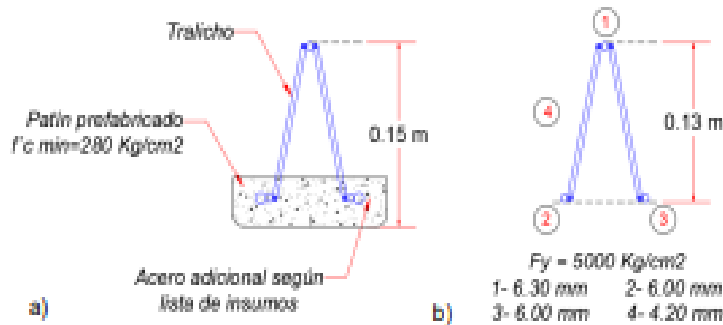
Esquema de las viguetas prefabricadas: a) Viguetas totalmente prefabricadas, b) Tralicho de refuerzo
